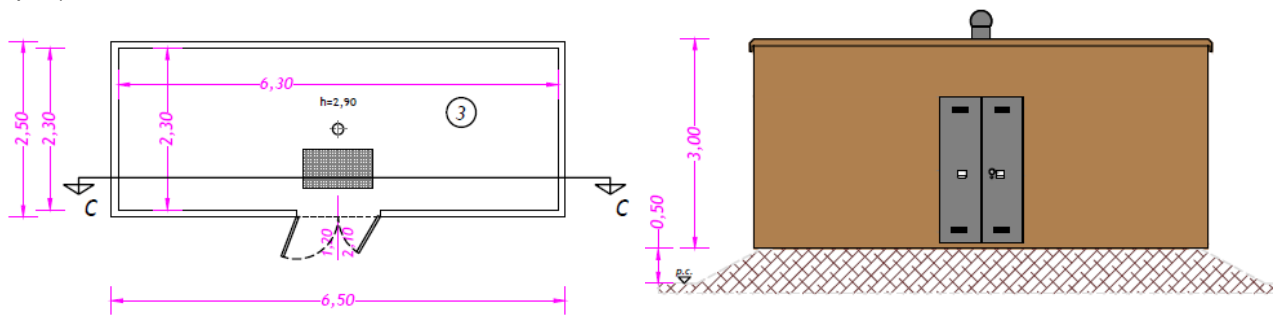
Pianta e profilo delle cabine MT Utente 1 e 2
